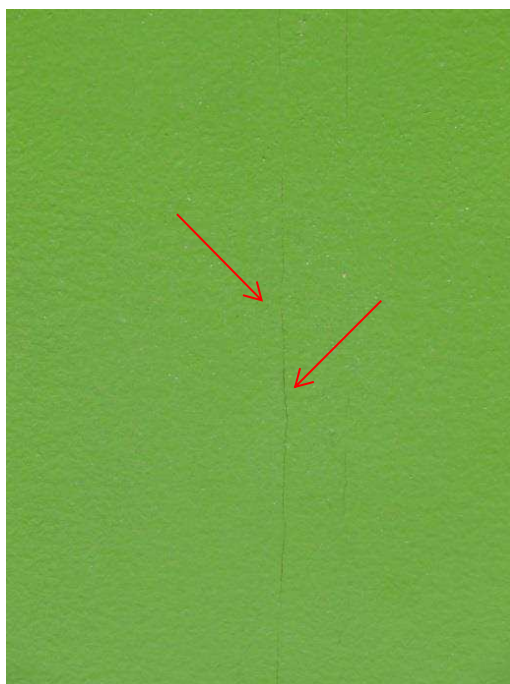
Junta de movimentação marcada por fissuras na fachada.
